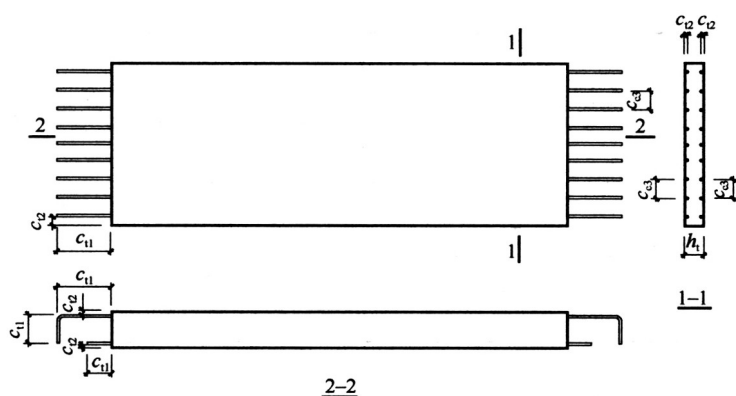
预制实心板预留外伸钢筋尺寸允许偏差示意
